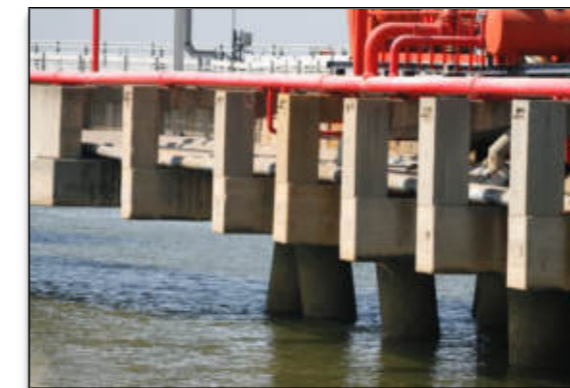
Atraque II: Hormigón de los pilares – soportes con avanzado estado de deterioro.
